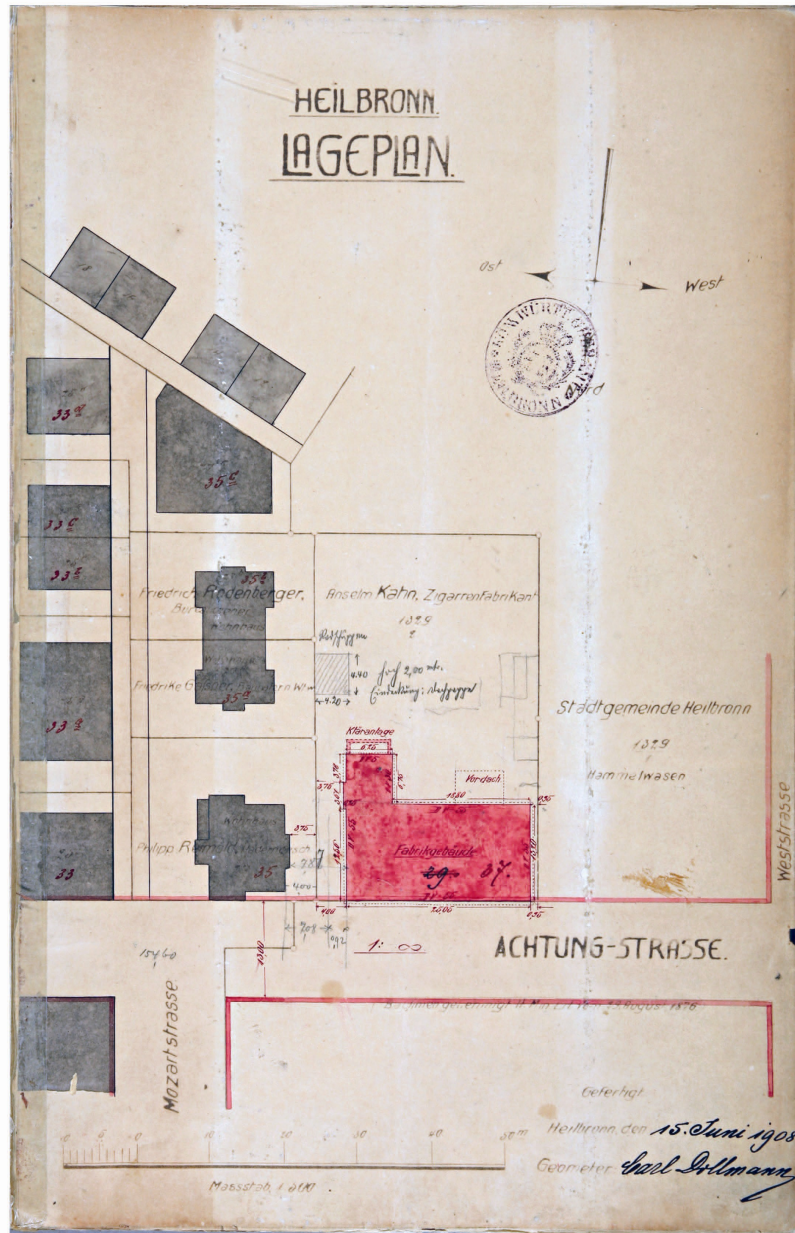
Lageplan der Zigarrenfabrik Kahn aus dem Jahre 1908. Foto: Stadtarchiv Heilbronn.
